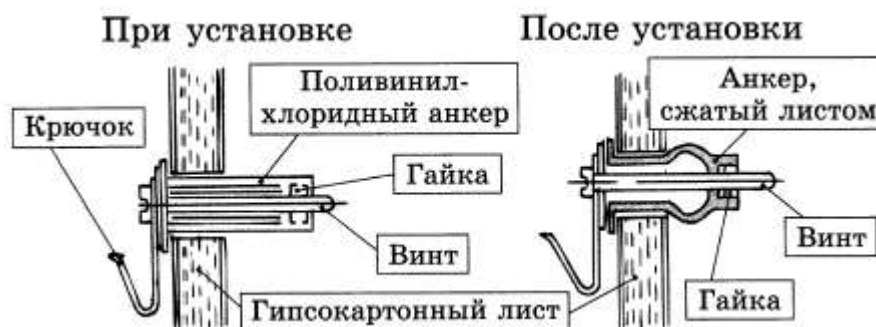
Крючки для крепления в гипсокартонных перегородках
